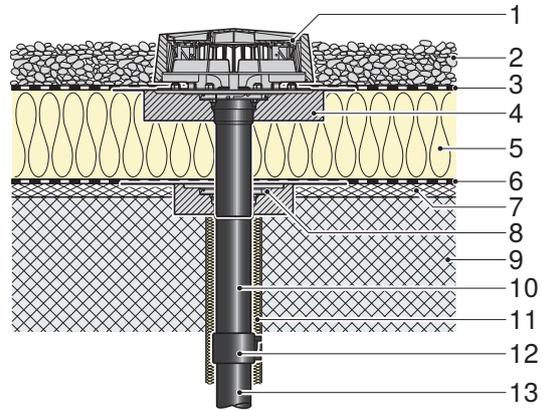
Монтаж на изолированной жесткой кровле с кровельным покрытием и пароизоляцией
